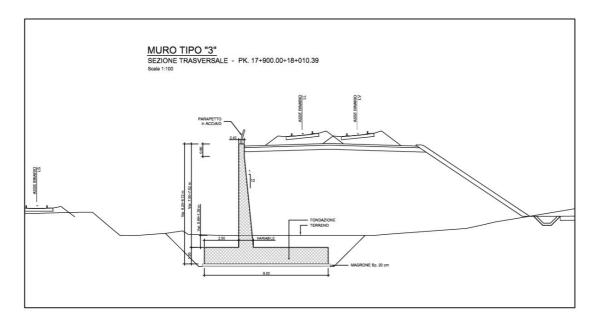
RI05: Muro di sostegno in sx MU03 – Sezione trasversale muro tipo 3.
